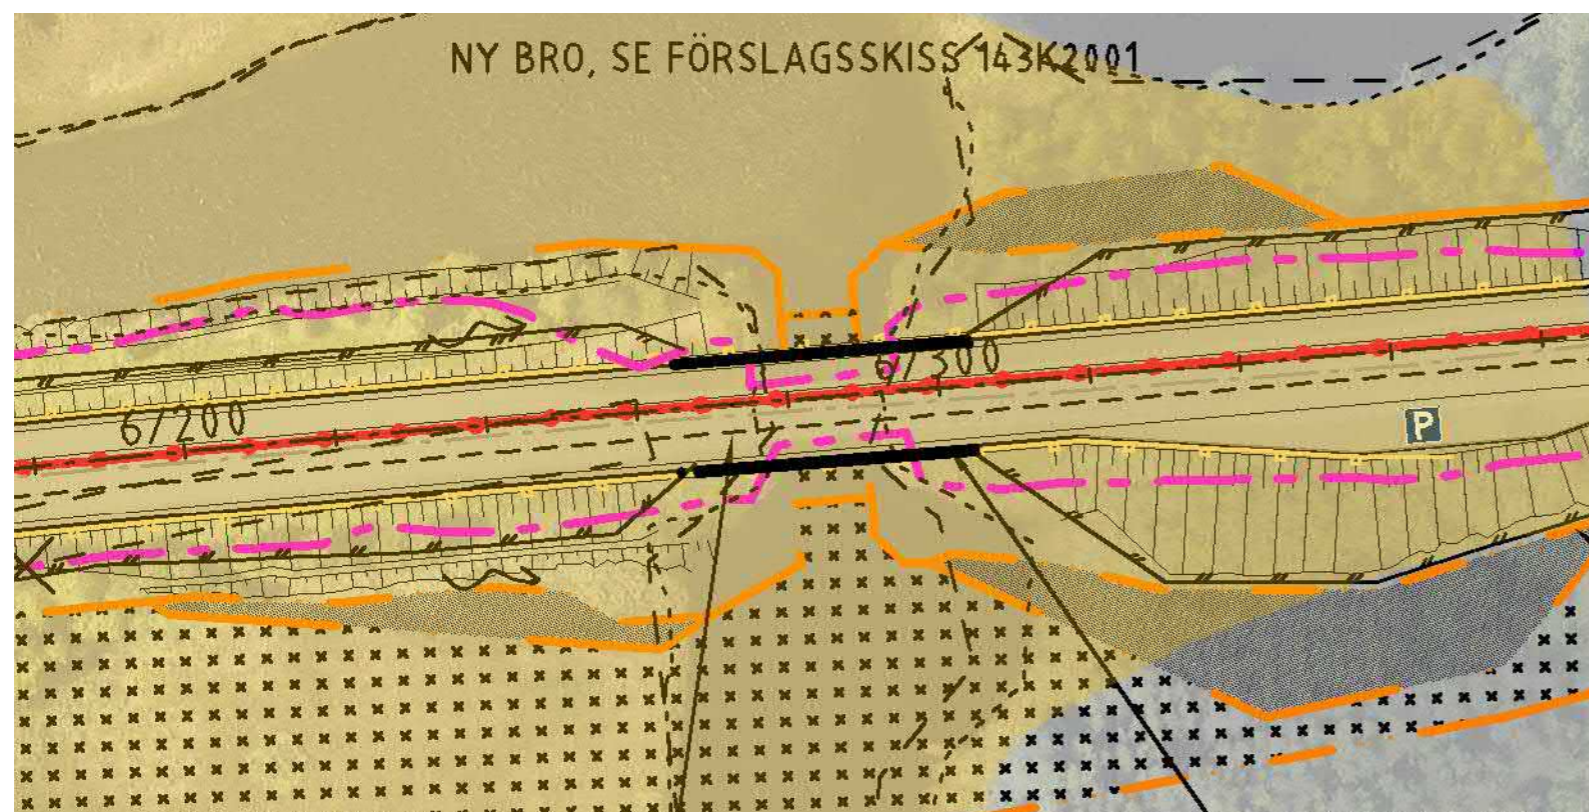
Planritning visande bro över Grundträskån.
